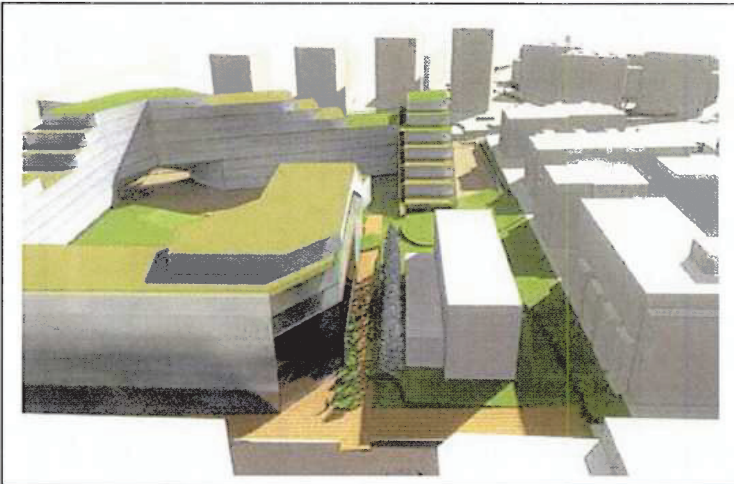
Bygningstruktur/utvikling av planområdet sett i forhold til Lorenveien og tilliggende bebyggelse.
